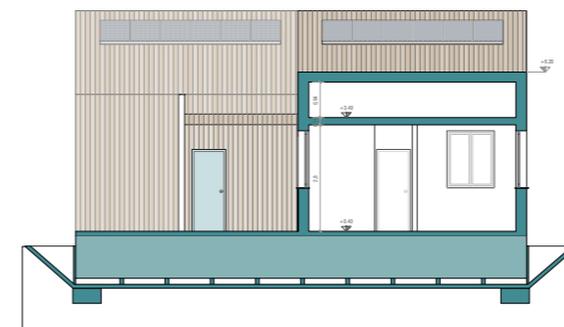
Sezione AA' modulo triplo - variante 1. Scala 1:200
